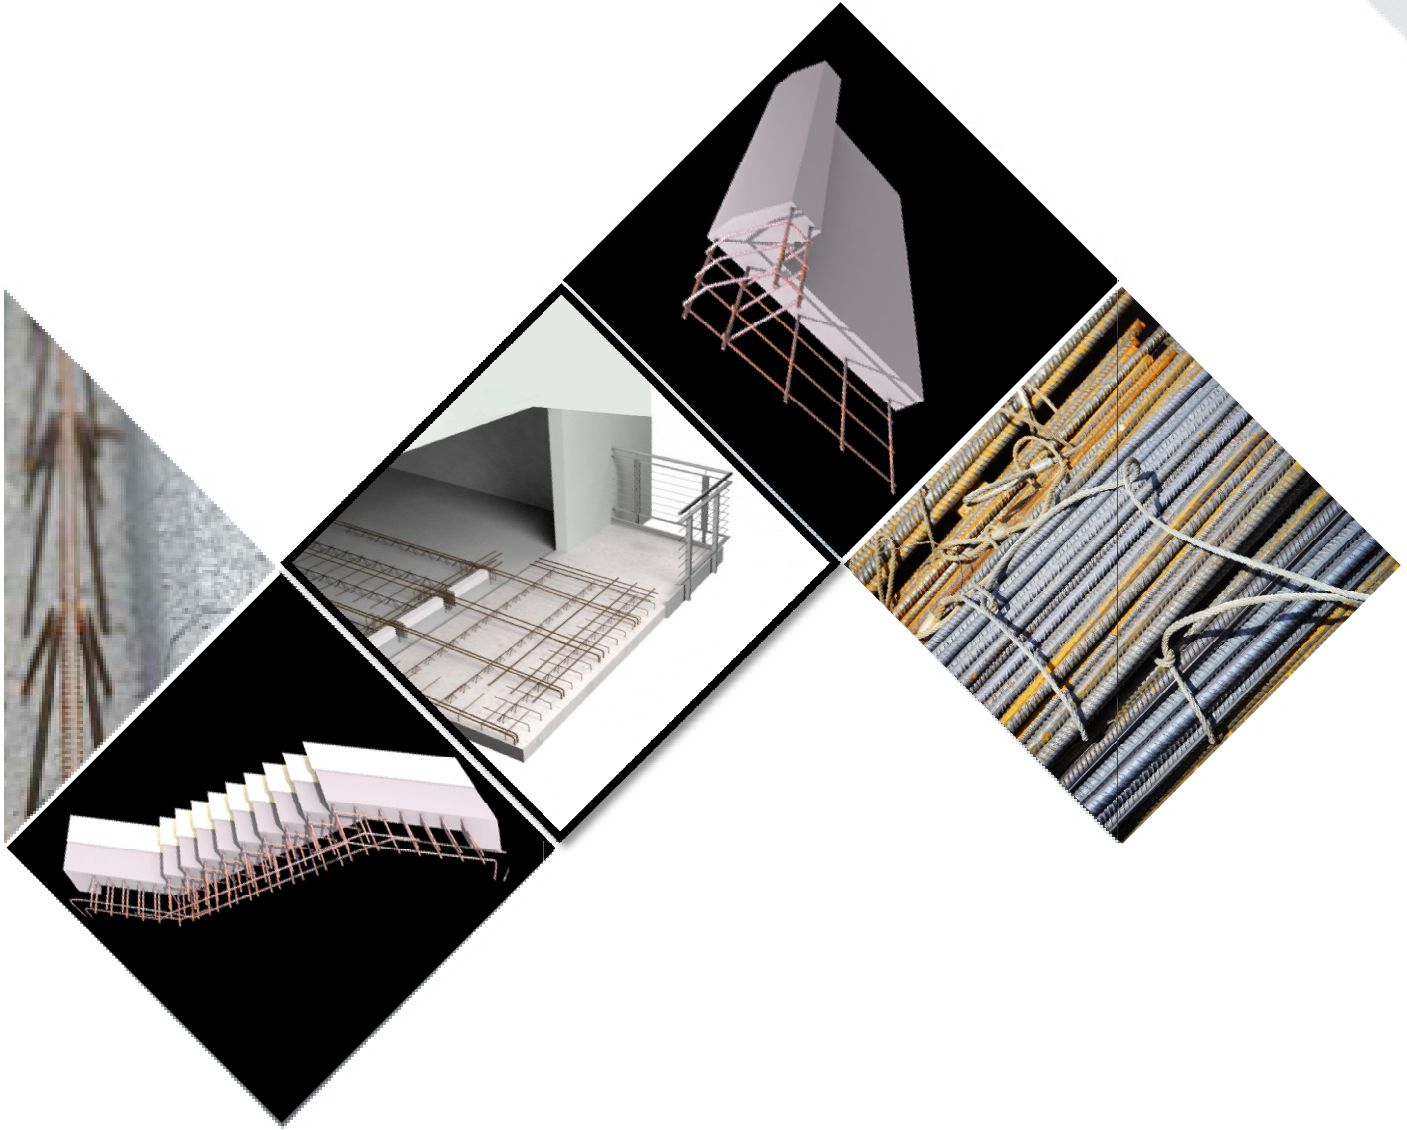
Schéma de ferrailage de la dalle pleine.
